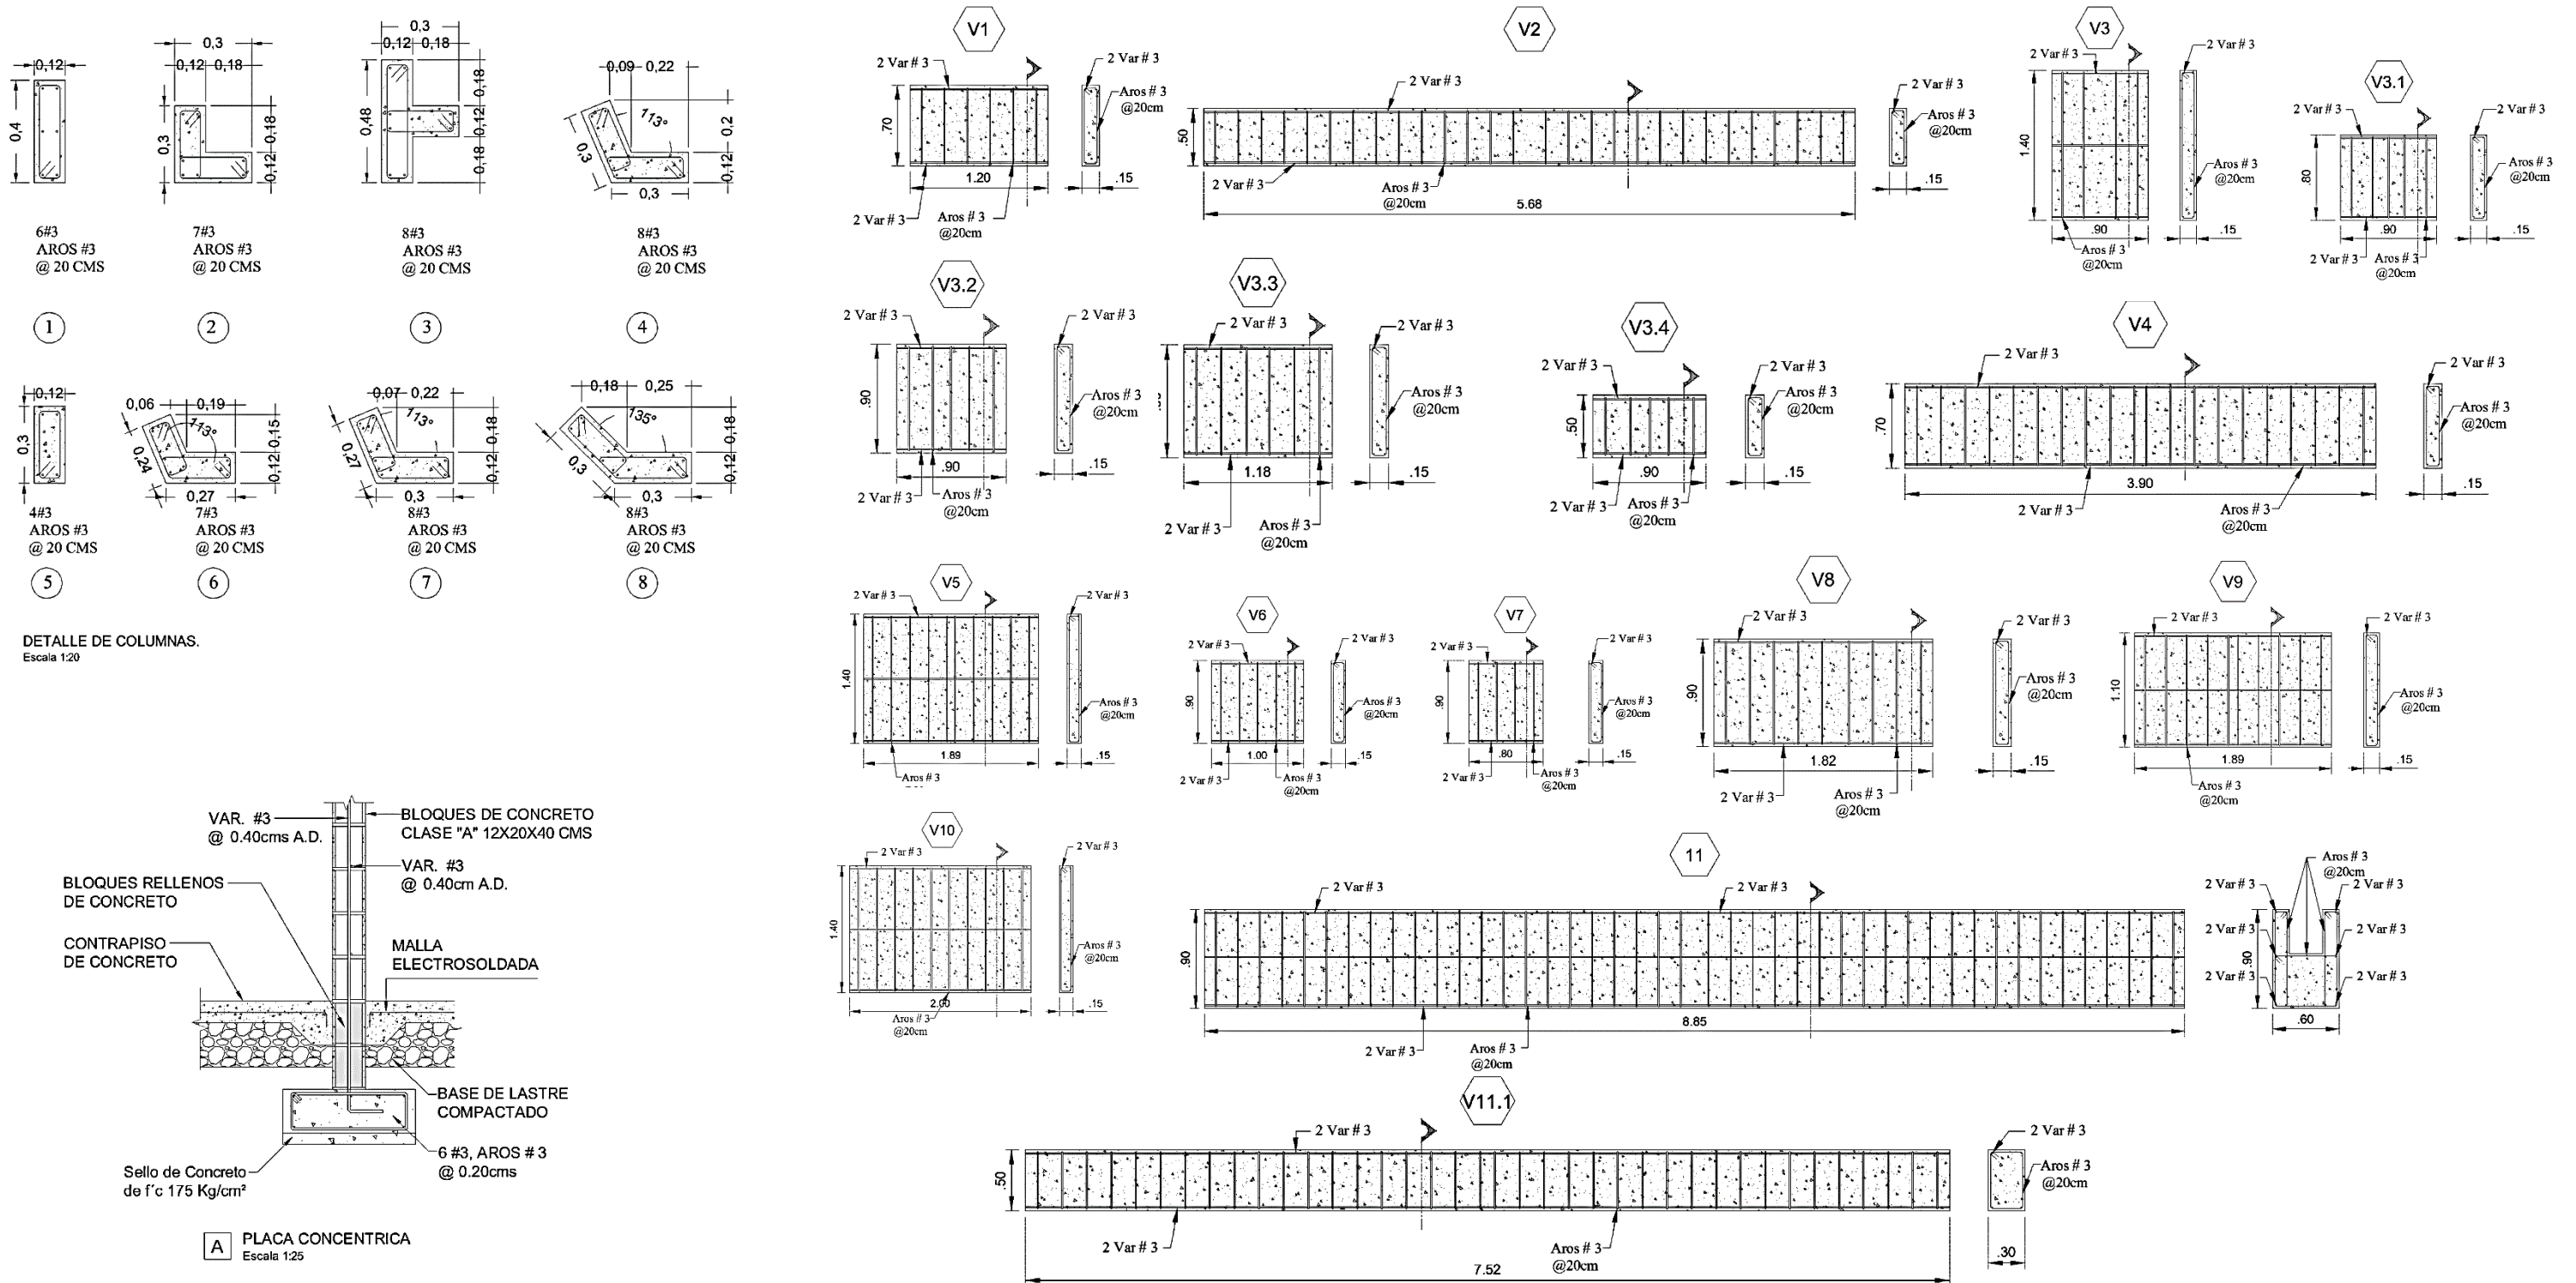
Detalles estructurales. Fuente: elaboración propia.
